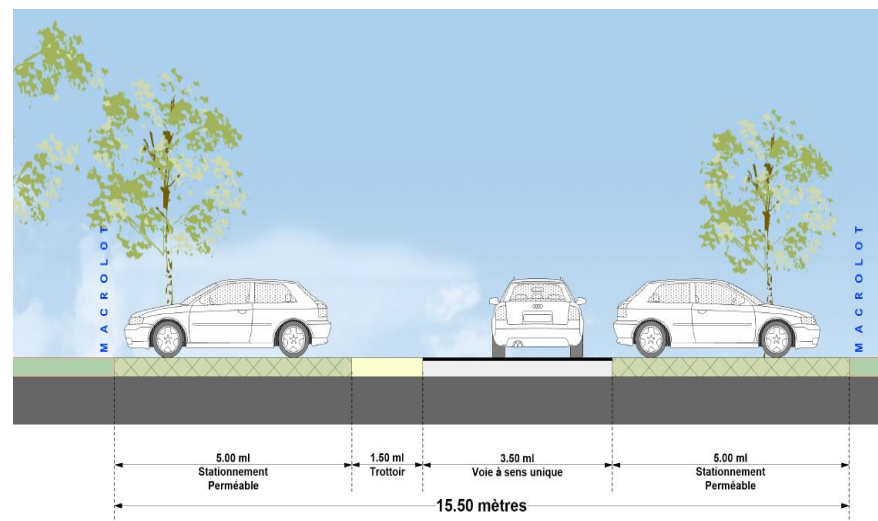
Coupe de voie secondaire (B) (sens-unique)
